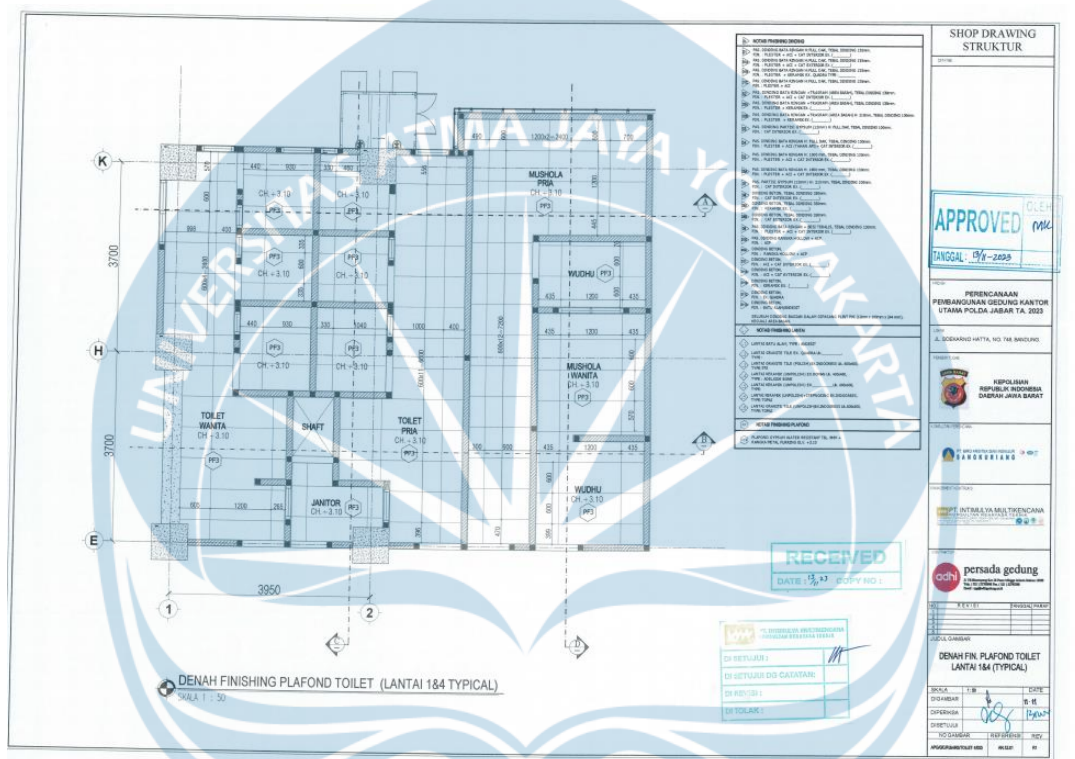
5 Gambar Denah Finishing Lantai Toilet 1 dan 4 Tipikal
